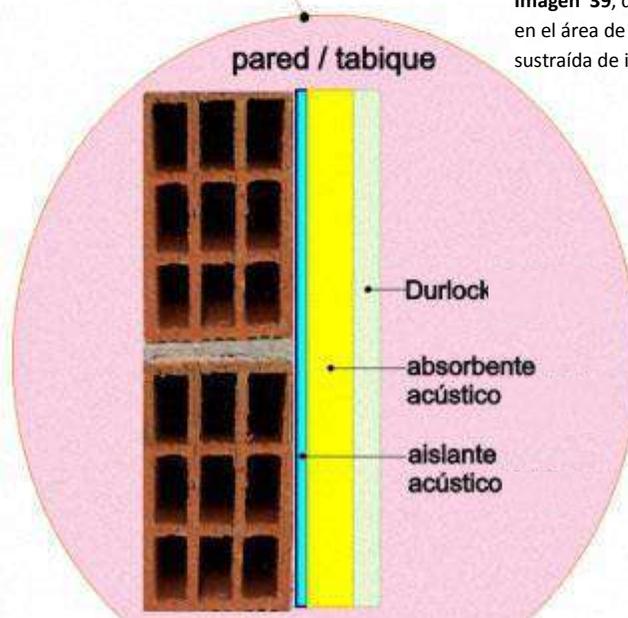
, que muestra el detalle constructivo empleado en el área de cabinas, a detalle, ilustración sustraída de internet y editada por E.A.A
